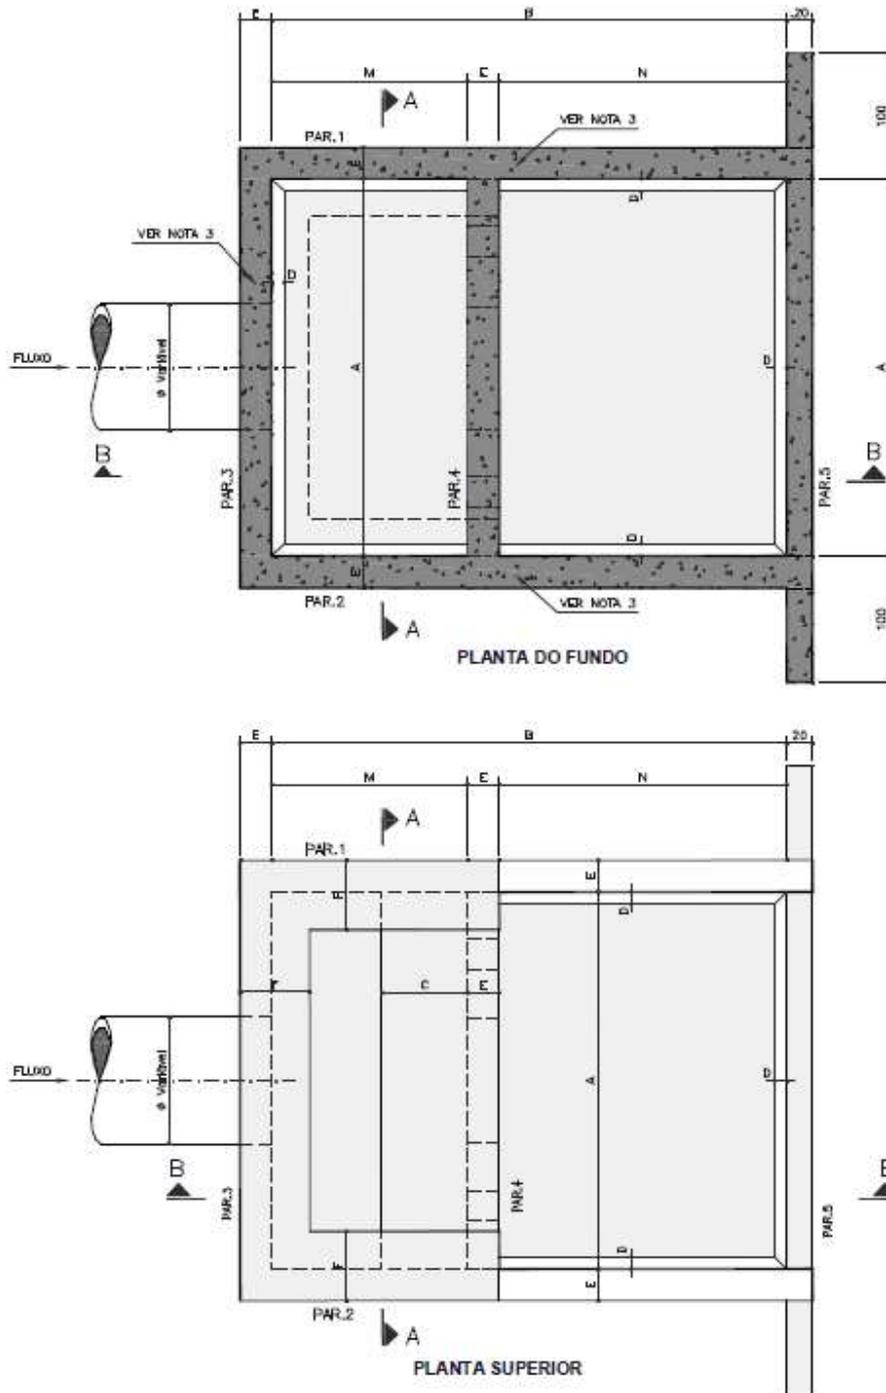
Detalhe Planta Baixa e Corte Dissipador
